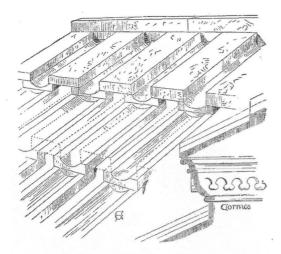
Ávila. Catedral, detalle de la cubierta (Street 1926)
